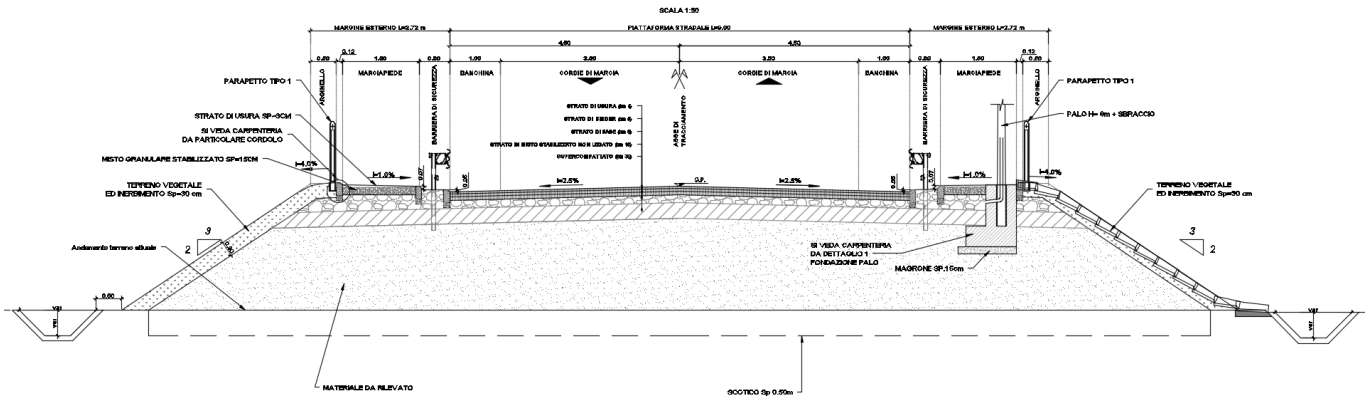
Asse 4 – Sezione tipo in rilevato con $H \geq 1$ m
